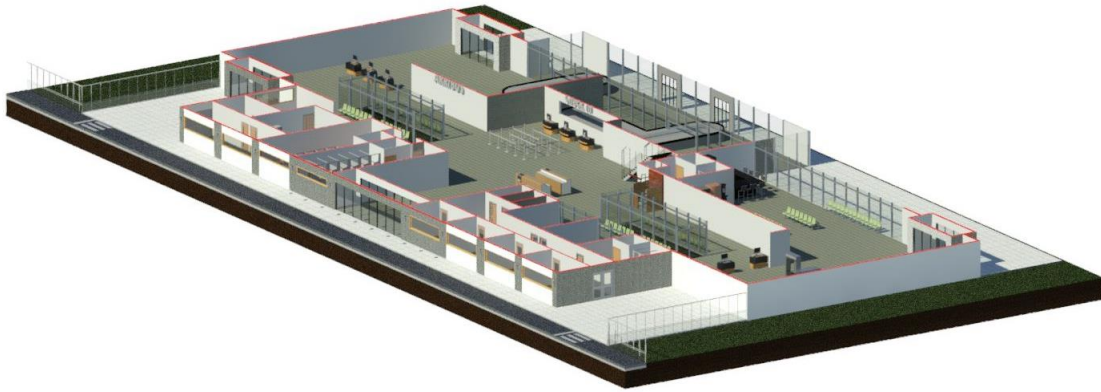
Modelo en 3D de la planta baja. Fuente: Elaboración propia
